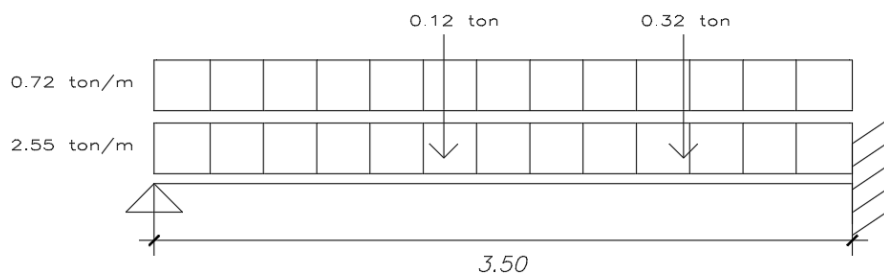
Metrado de Carga Muerta y Viva en Servicio
